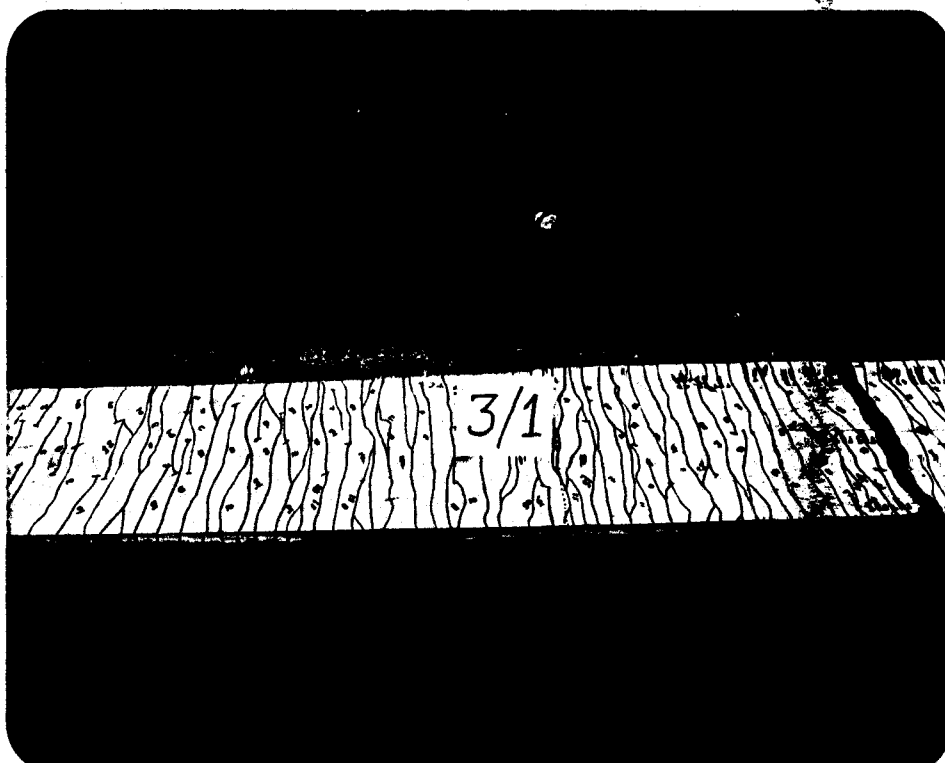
Configuração de fissuras final do modelo 3/1, armado com tela soldada ensaiado por Giongo<sup>(22)</sup>.
